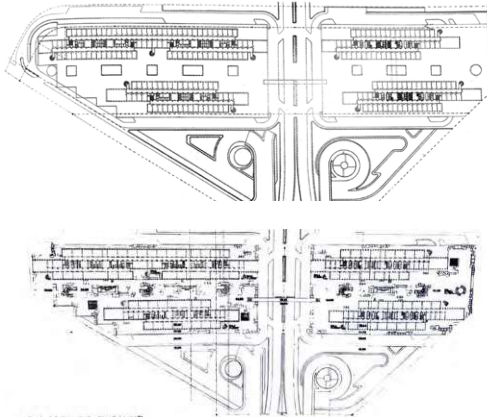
Grundrisse Regel- und Gartengeschoß aus Pietro Barucci architetto
